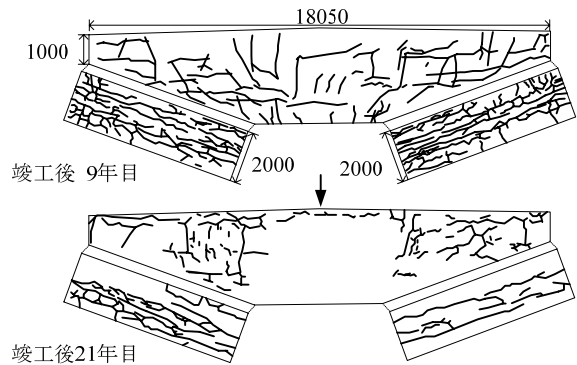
実構造物のひび割れ性状（代表橋脚 B）
